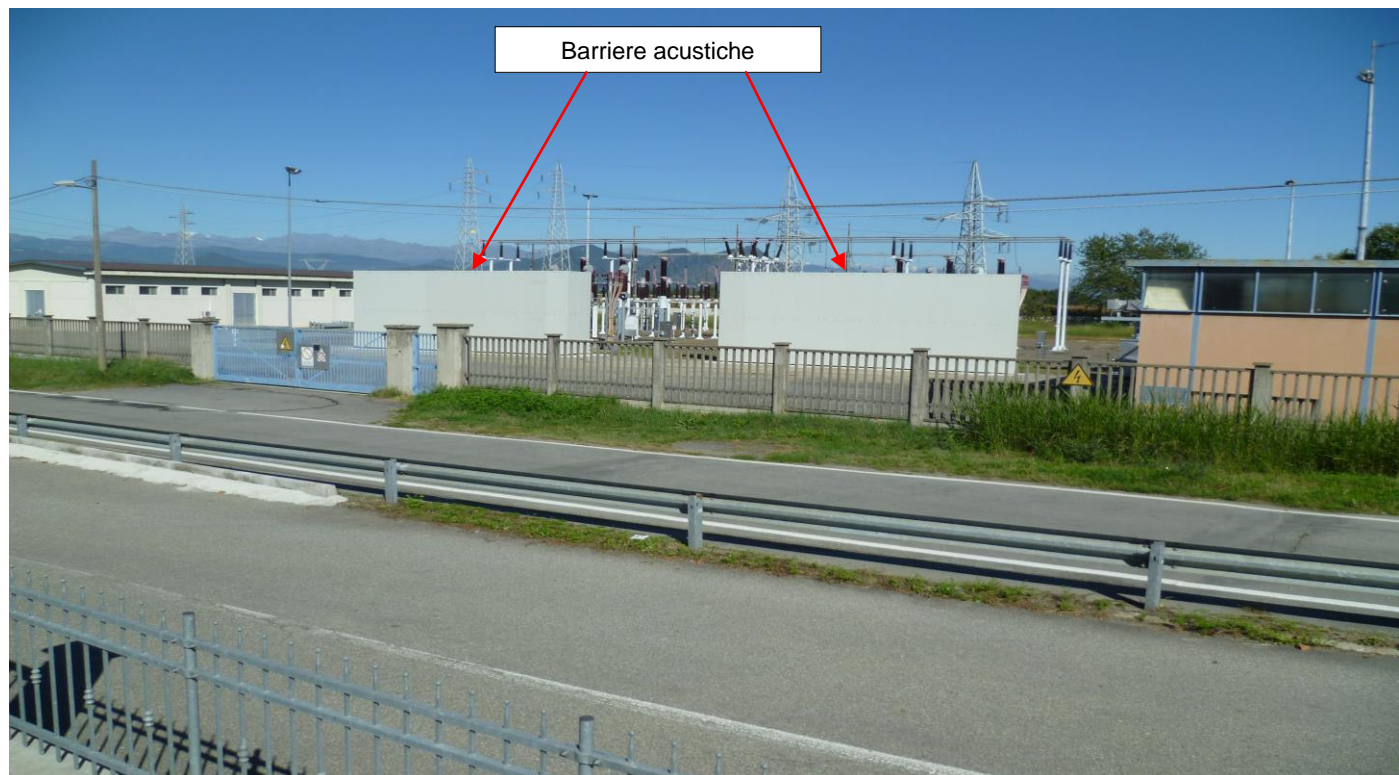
Vista della centrale ENEL dall'abitazione del ricettore
